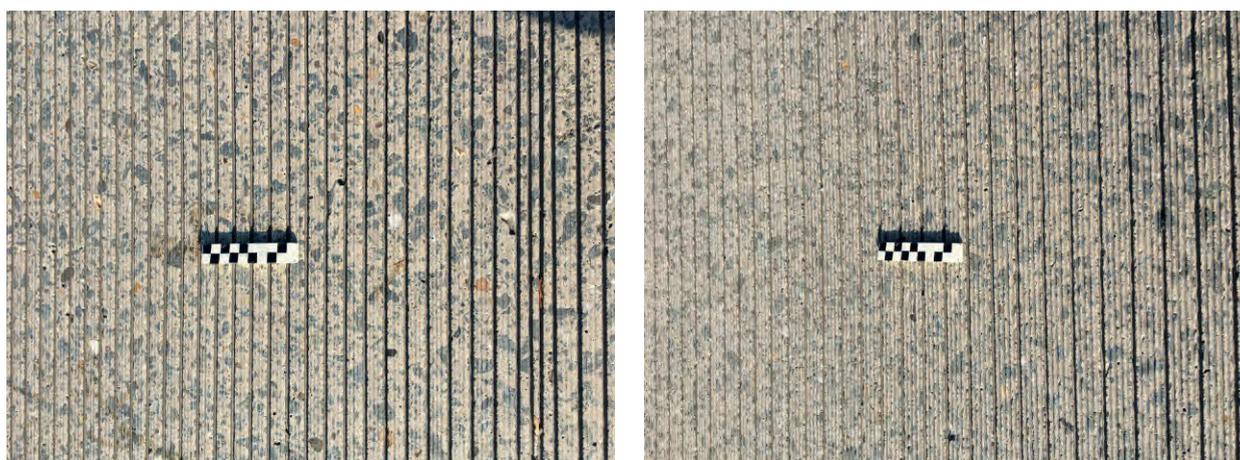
Detalle de la sección de prueba de NGCS en Bélgica. [2]
